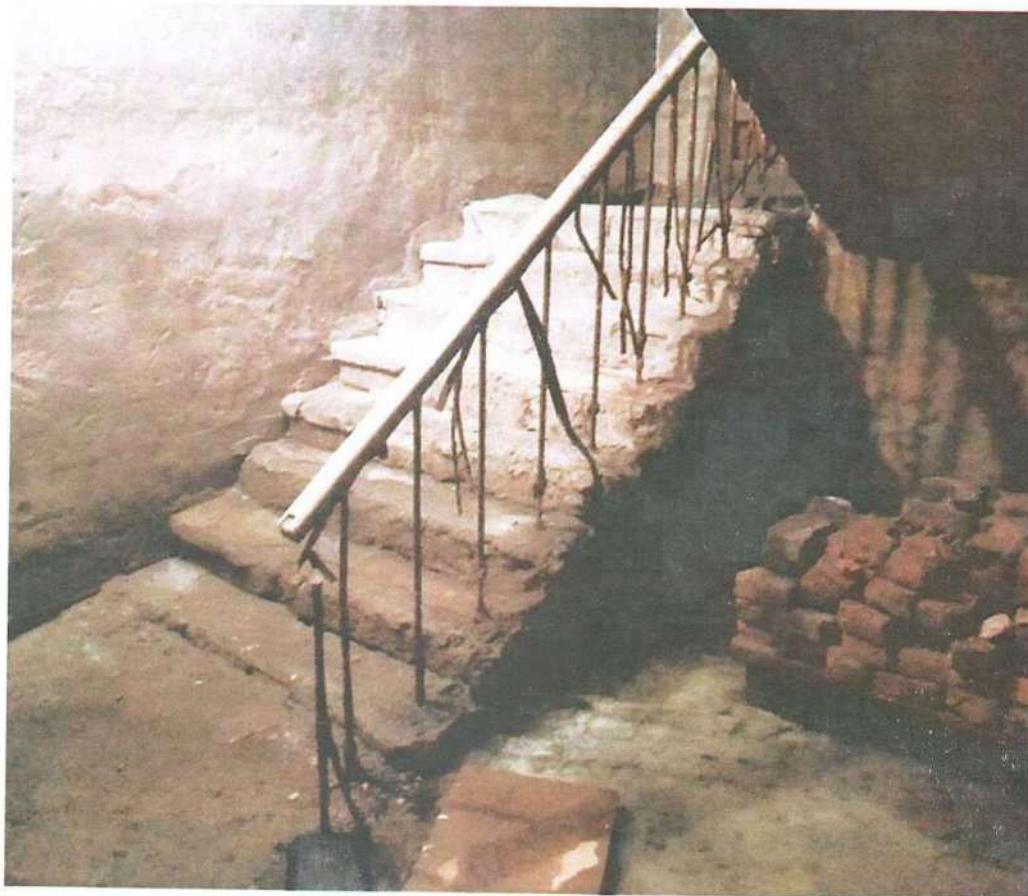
Состояние лестничного марша в подвале в помещения бывшей котельной (лестница в осях 3-4, А-Б) – металлическое ограждение сгнило, бетон ступеней лестницы разрушается
